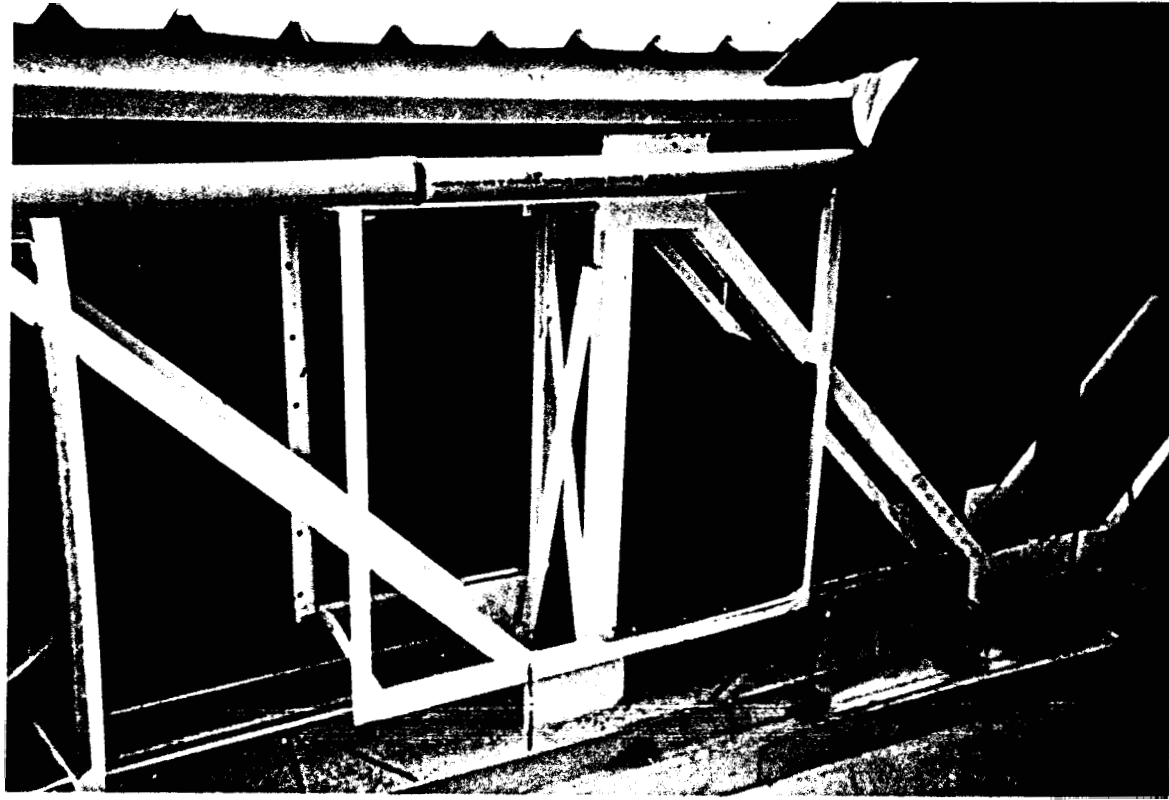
DETALLE DE PADO DE DUCTOS Y CORTES EN ESTRUCTURA ORINCIPAL
